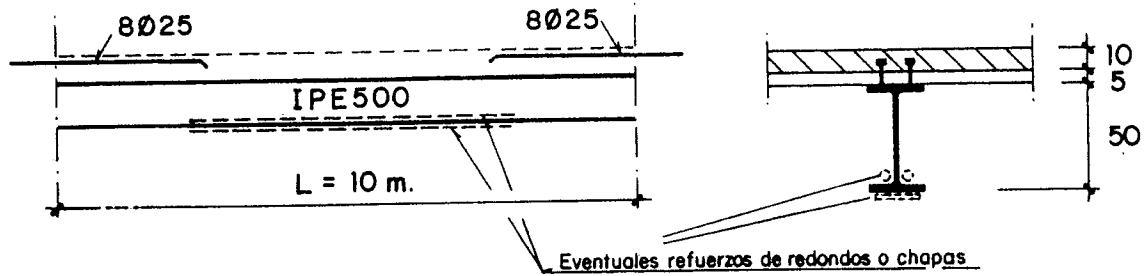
Empotramiento elástico de vigas mixtas con soportes de hormigón.
